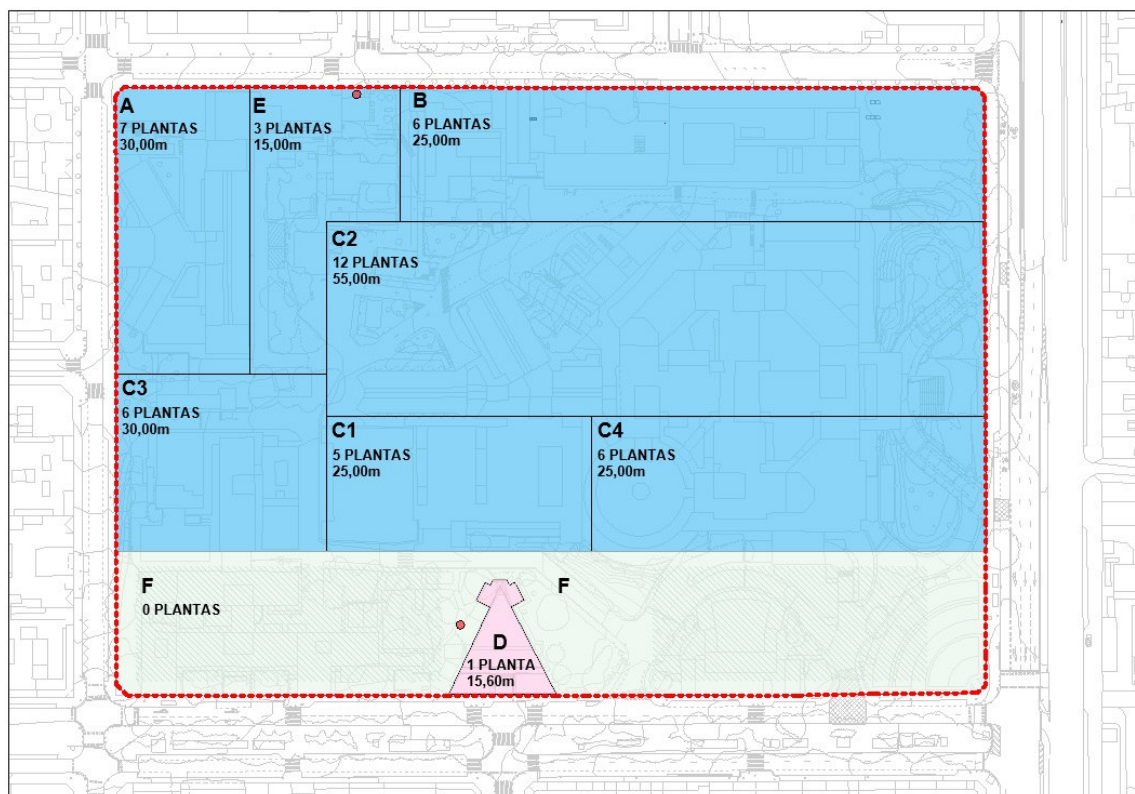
Extracto del plano de ordenación con indicación de zonas de ordenanza
